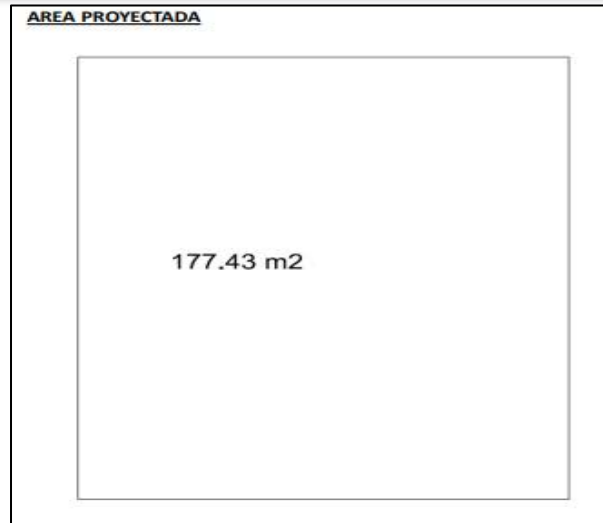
Plano de área proyectada en el diseño de planta de proceso deshidratado
